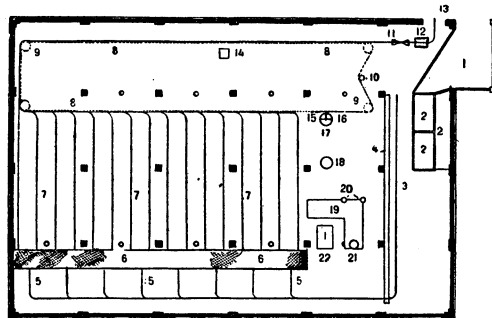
Схематический план бойни крупного скота, с расположением подвесных путей (американский тип): 1) загон для животных, 2) убойная клетка, место для бойца-глушителя, 3) рельс обескровливания, 4) желоб для стока крови, 5) тушки, где снимается голова и спускается на пол туша, 6) место на полу бойни, где производится первоначальная разделка, 7) рельсы для разделки, 8) кольцевой путь с конвейером для разделки туши, 9) зубчатые шестерни для пеги конвейера, 10) натяжная шестерня, 11) весы, 12, 13) путь в холодильнике, 14) отверстие в полу для спуска коз в нижние этажи, 15) спуск гусака, 16) спуск кишек, 17) спуск желудка, 18) спуск забранованных органов, 19) стол для осмотра голов, 20) спуск языков, 21) спуск костей головы, 22) пила для рогов.
